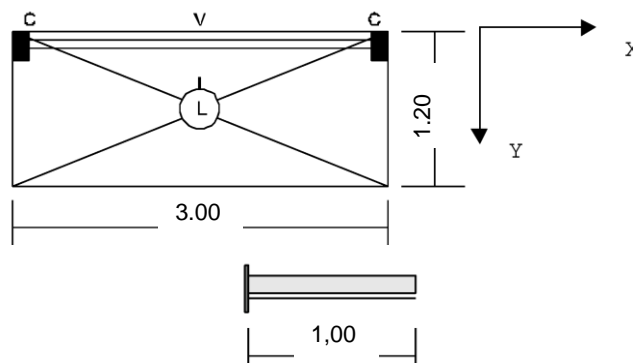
Planta de la columna correspondiente al ejercicio 2)
